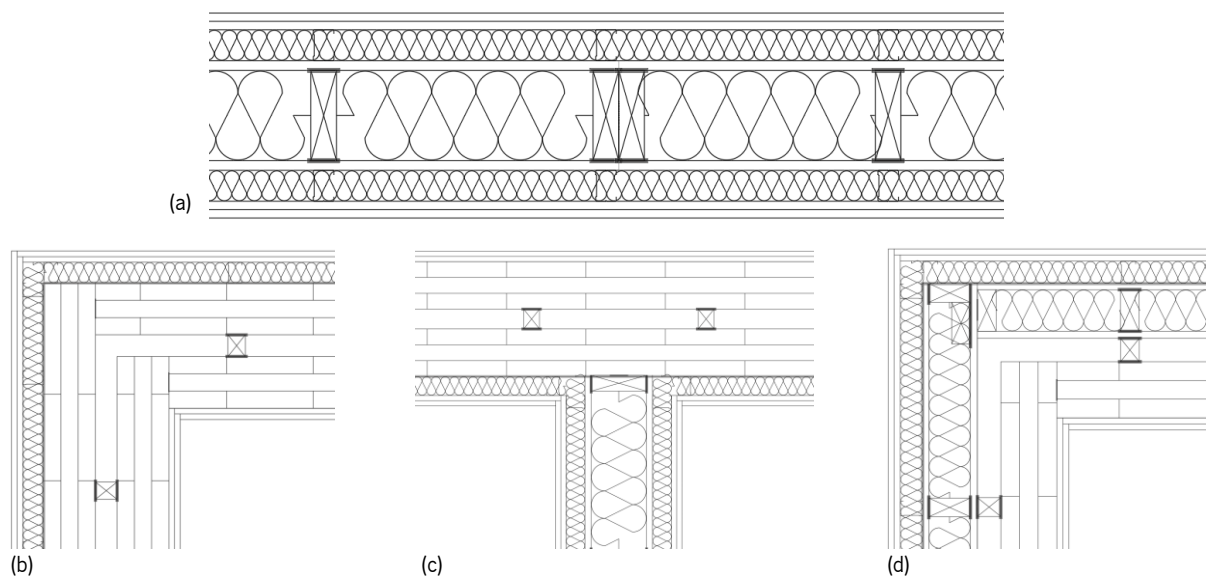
(a) Junção a 180° entre duas paredes em *timber-frame*. Exemplo: Par_Int_Est_TF; (b) Junção entre duas paredes em CLT. Exemplo: Par_Nuc_CLT; (c) Junção entre uma parede em CLT e uma parede em *timber-frame*. Exemplos: Par_Nuc_CLT e Par_Int_Est_TF; (d) Junção entre duas paredes mistas. Exemplo: Par_Nuc_CLT_TF
